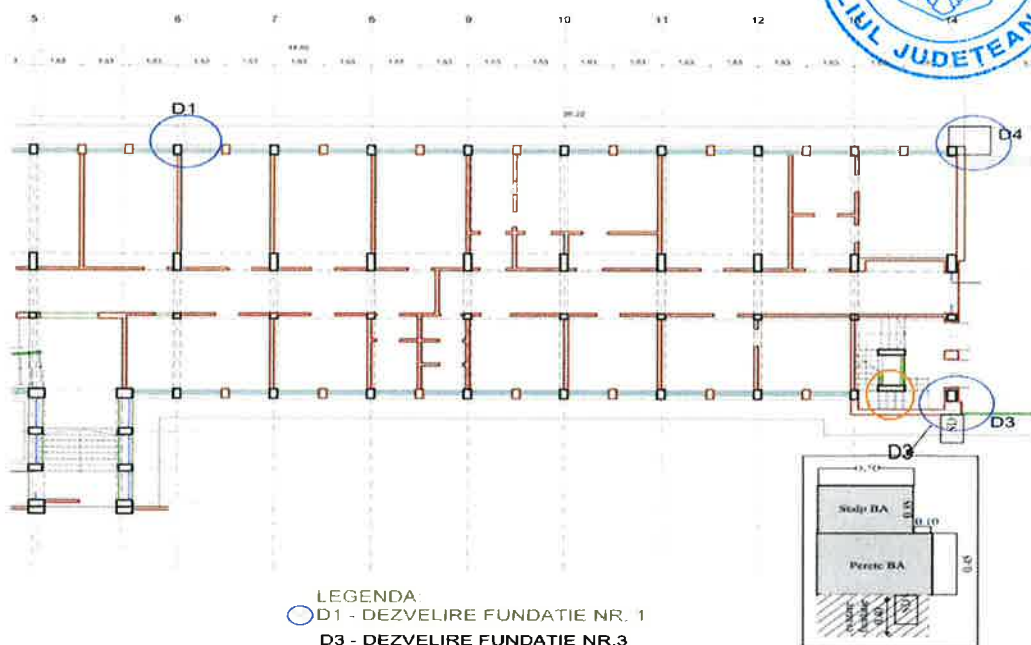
Plan poziționare dezvelire fundații și foraj
